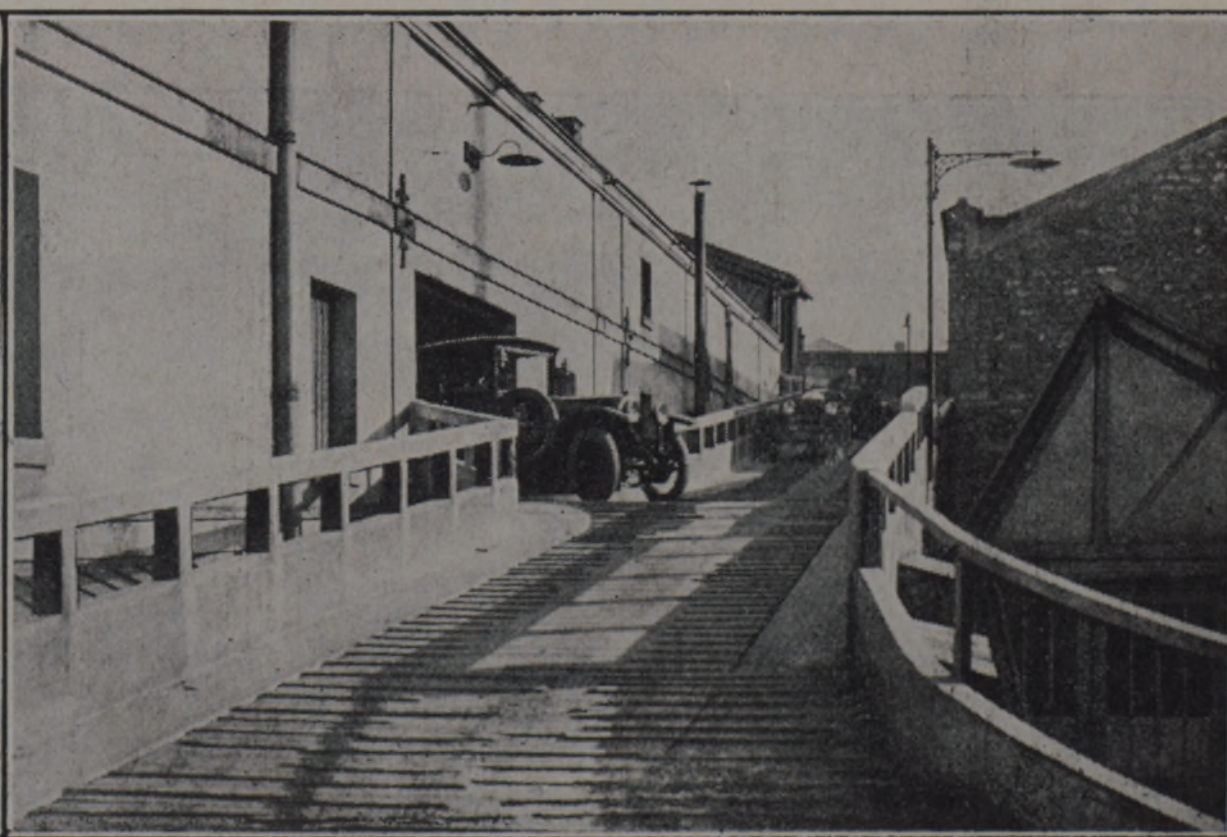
Fig. VIII. — GARAGE A RAMPE EXTERIEURE. — Photographie prise au garage Bobillot. La rampe placée à l'extérieur dessert deux étages.
